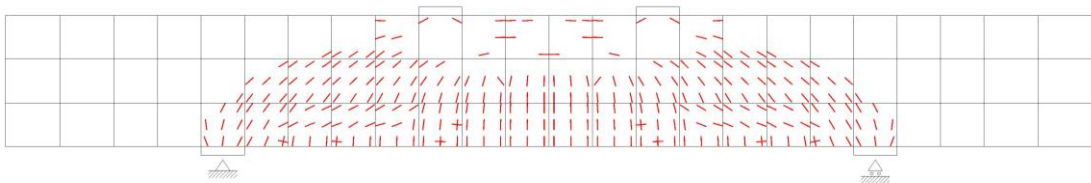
破壊時の変形及びひび割れ状態 (Case No. 9)
